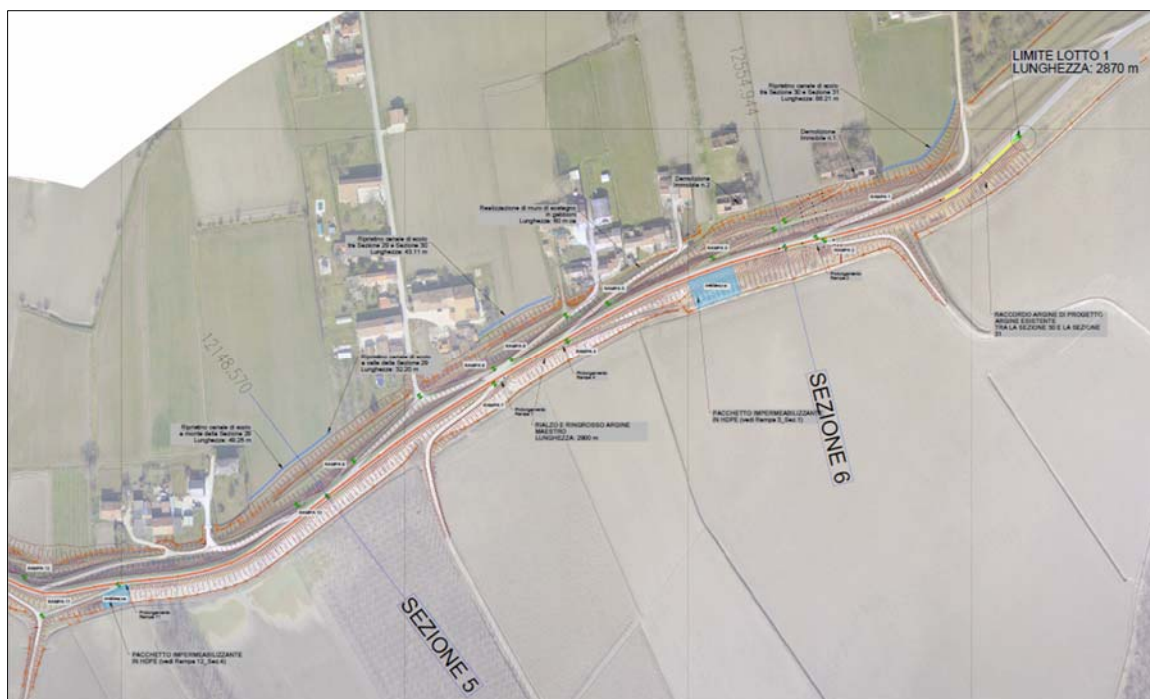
Esempio di dettaglio planimetrico del rilevato arginale di progetto.
